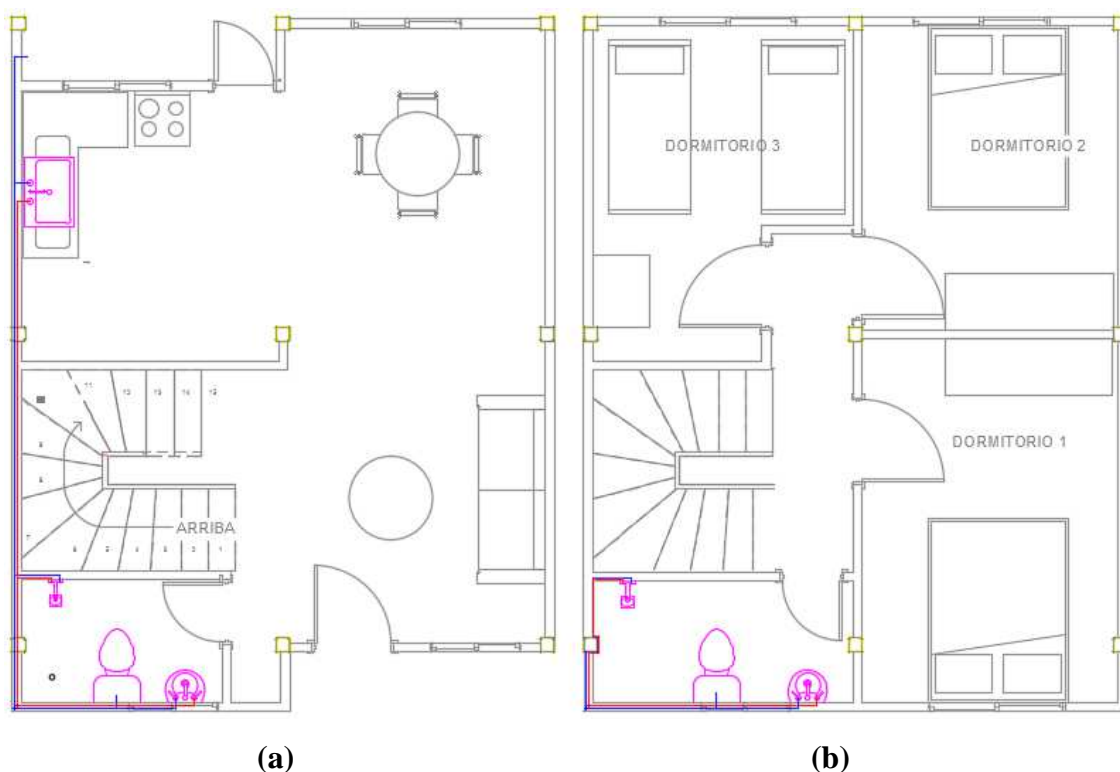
Tubería de planta baja (a) y segunda planta (b)
